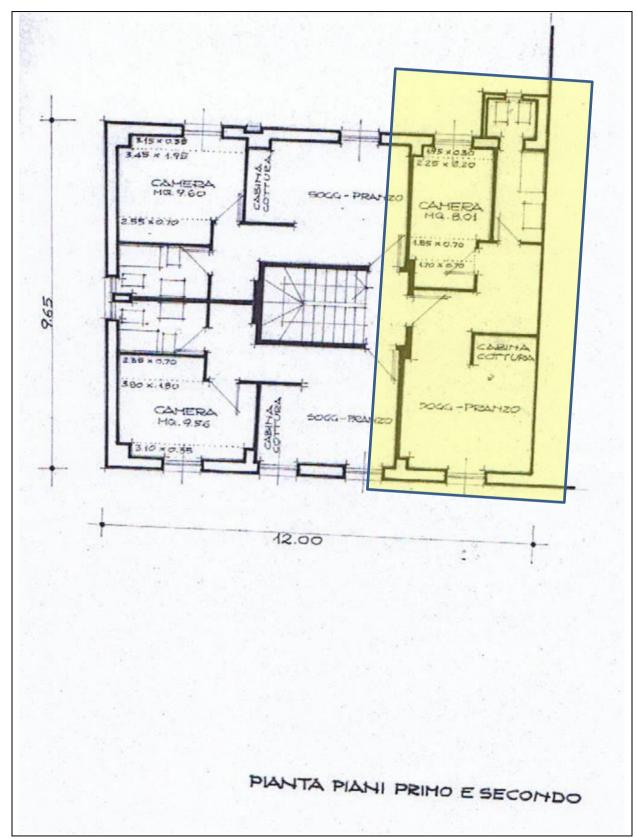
Stralcio rappresentazione piani correnti 1 e 2 allegata a variante aut. 11430 del 28/06/1976
